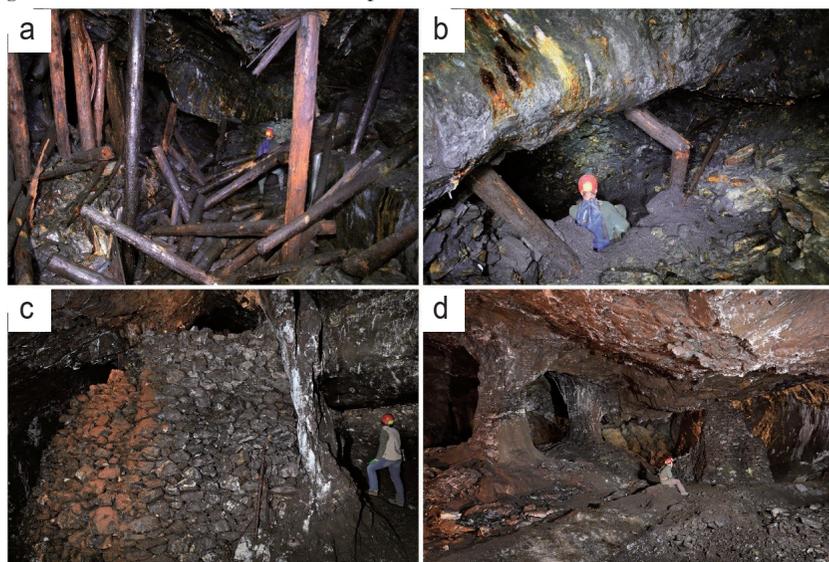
Planche photographique montrant des exemples d'effondrement/affaissement de toit de galerie souterraine, ainsi que des murs de soutènement mis en place pour prévenir les mouvements de masse. a) Bois d'étagage en «mikado» dans la mine d'Arêches-Beaufort mettant en évidence la subsidence du toit de la salle. b) Bois d'étagage fendu sous l'effet de l'affaissement du toit de la galerie (mine d'Arêches-Beaufort). c) et d) Murs de soutènement du toit des salles en partie défilées (mine de Saint-Georges d'Hurtières).
